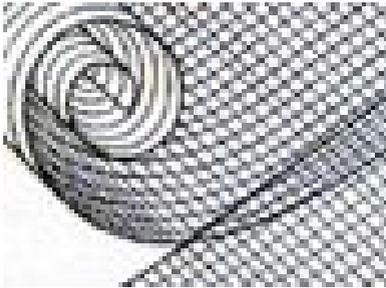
Solape entre mallas de fibra. 2014. Fichas técnicas TopCiment.
